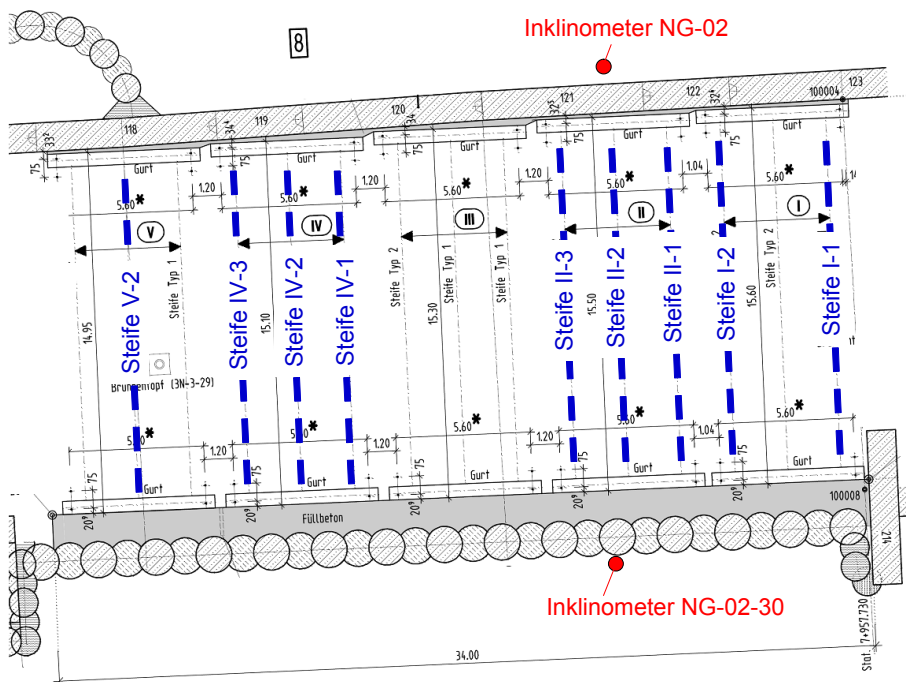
Grundriss Lage Inklinometer und Steifen - U-Bahn-München, Linie U3, Nord 3, Bf. Moosach
